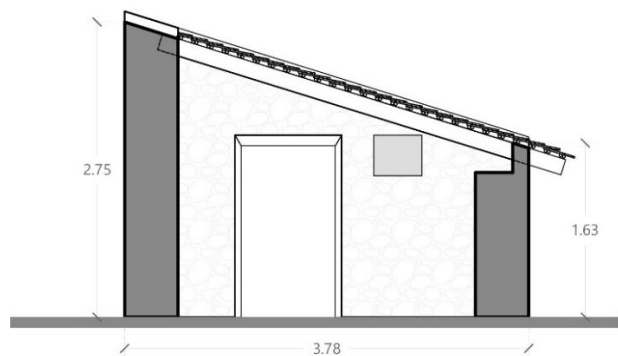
Corte transversal A-A'. Casa de Piedra, ejemplo 1. Fuente: Elaboración propia.
